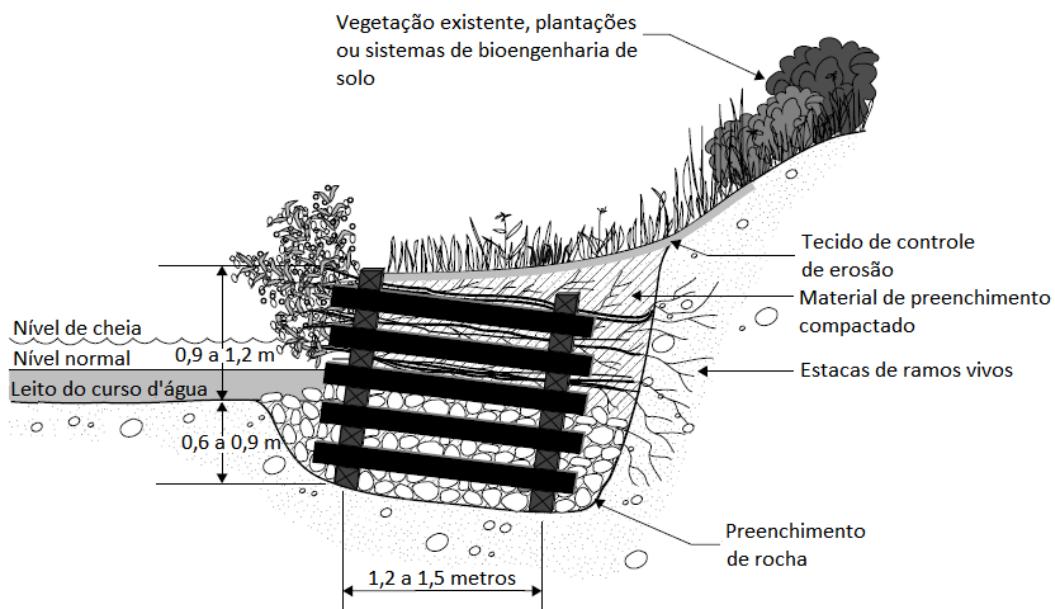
Detalhes do muro de suporte vivo. Fonte: Adaptado de USDA (1996)
